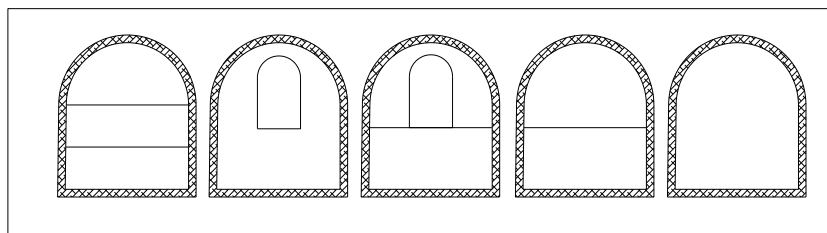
Sistemas de avances en la excavación de túneles y galerías
